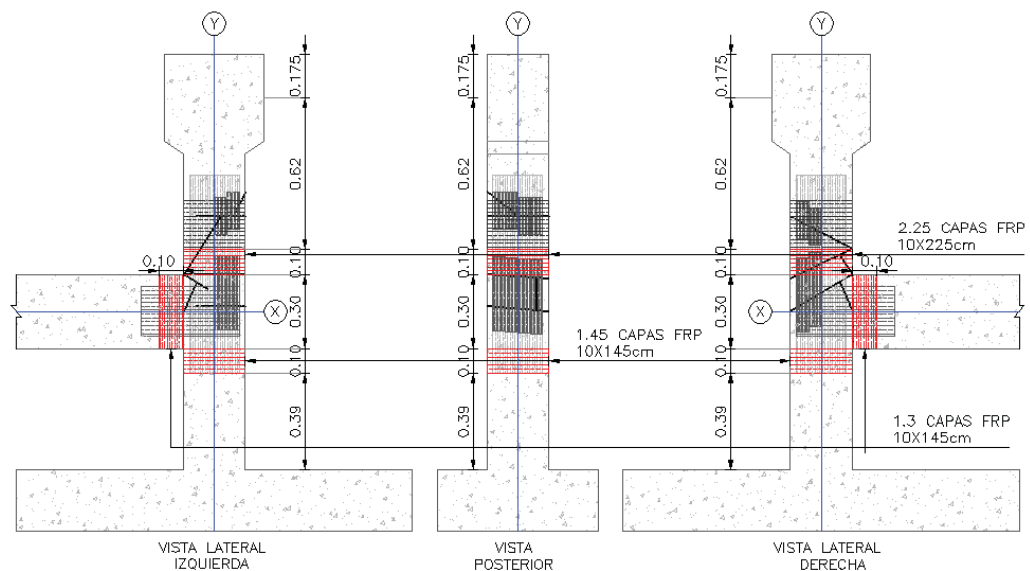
Refuerzo a flexión en la viga de la probeta.
